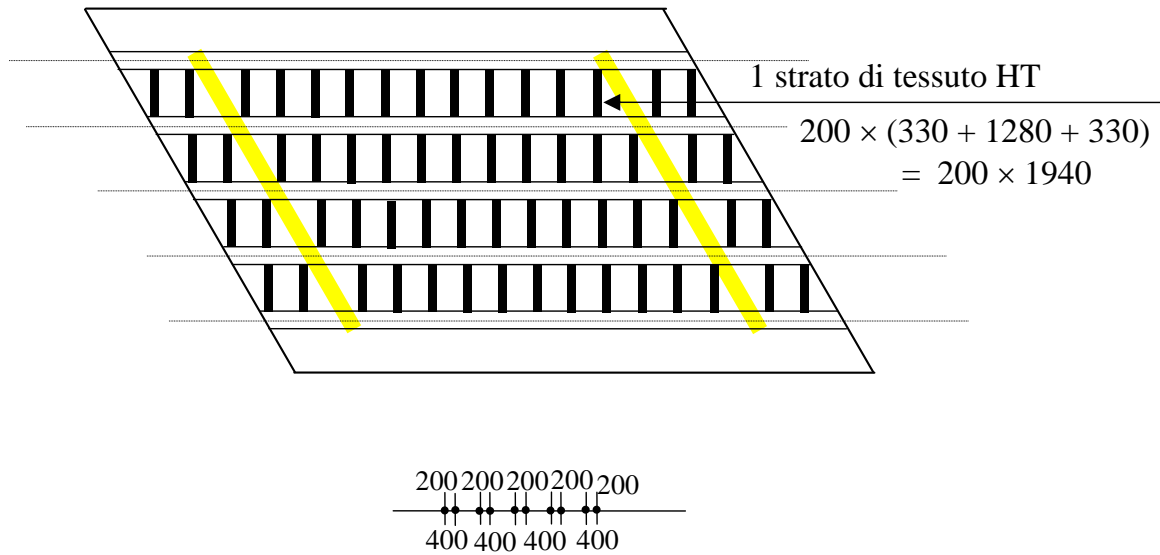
h: Pianta complessiva dell'impalcato. Intervento finalizzato all'incremento della portanza flessionale trasversale della soletta.
